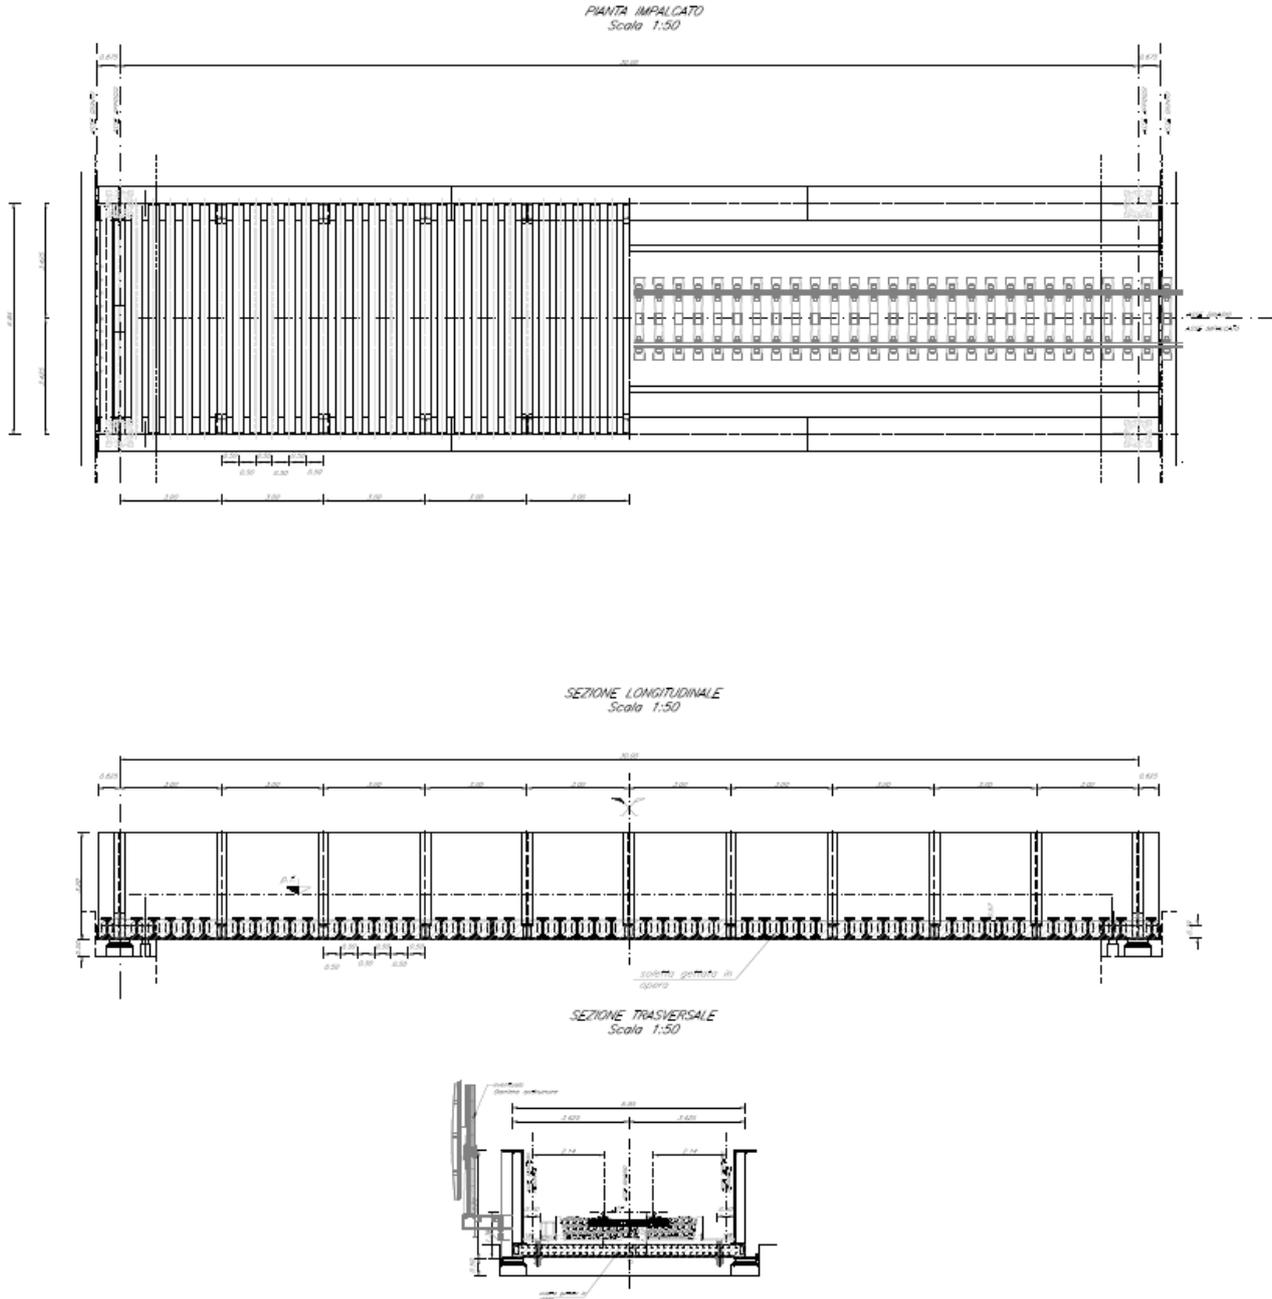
Impalcato a parete piena a via inferiore – L=30,00 m – singolo binario
